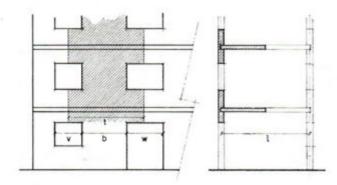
CARGA TRANSMITIDA SOBRE UN ELEMENTO DE MURO DE ANCHO «b»
